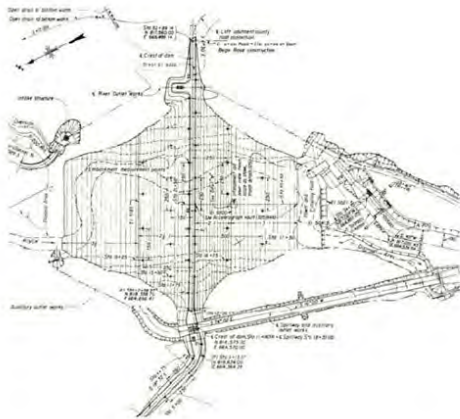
Detalii de construcție a barajului Teton, vedere în plan
